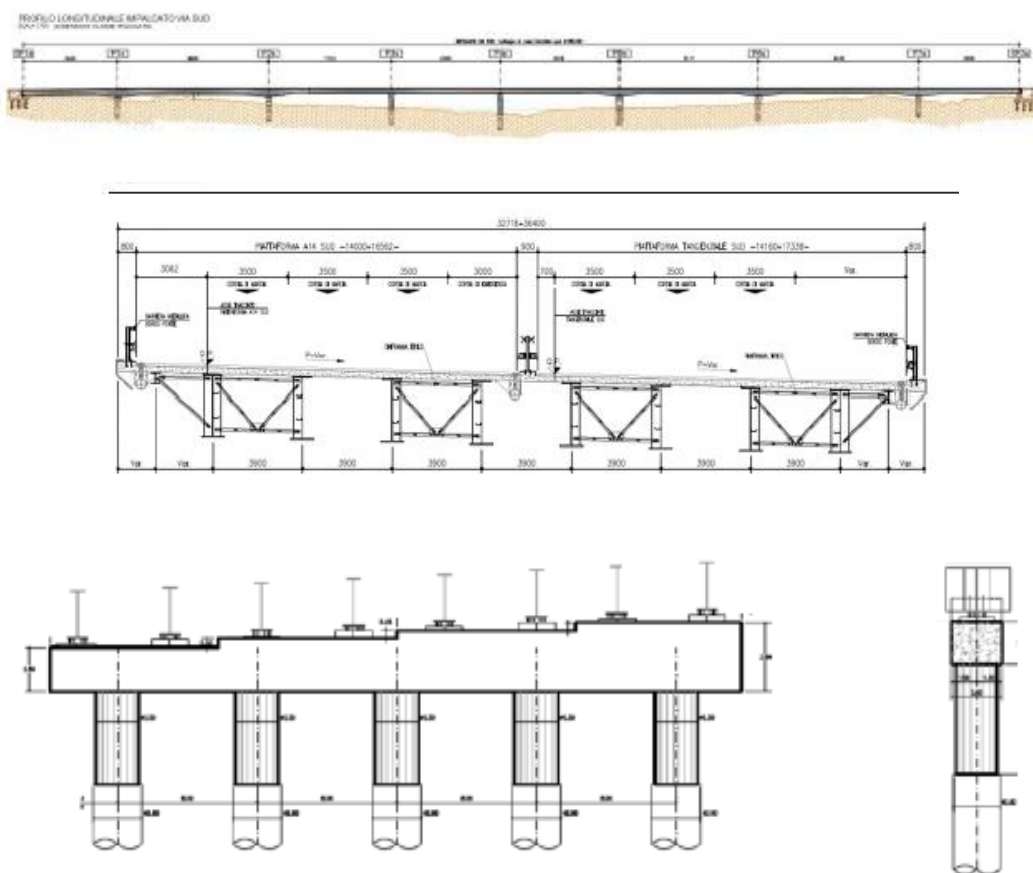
Vista longitudinale, sezione trasversale e pila tipica del nuovo viadotto sul fiume Reno
